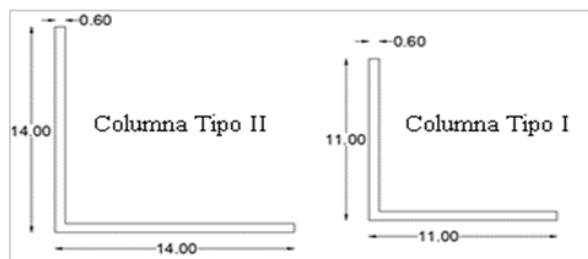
Columna Tipo I, II, (dimensiones en mm).
